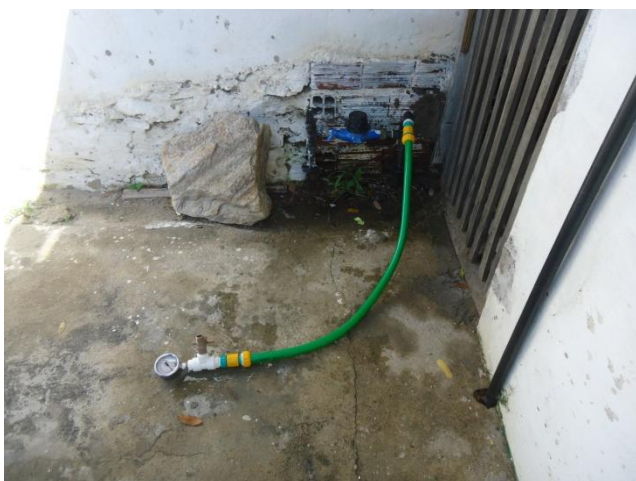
Medição instantânea de pressão disponível na rede de distribuição – Rua Cel João Paracampos, 1297.
